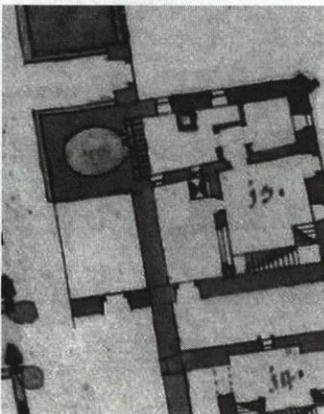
Obermünsterplatz 8, Grundriss vor 1766 (Münchener Plan).
